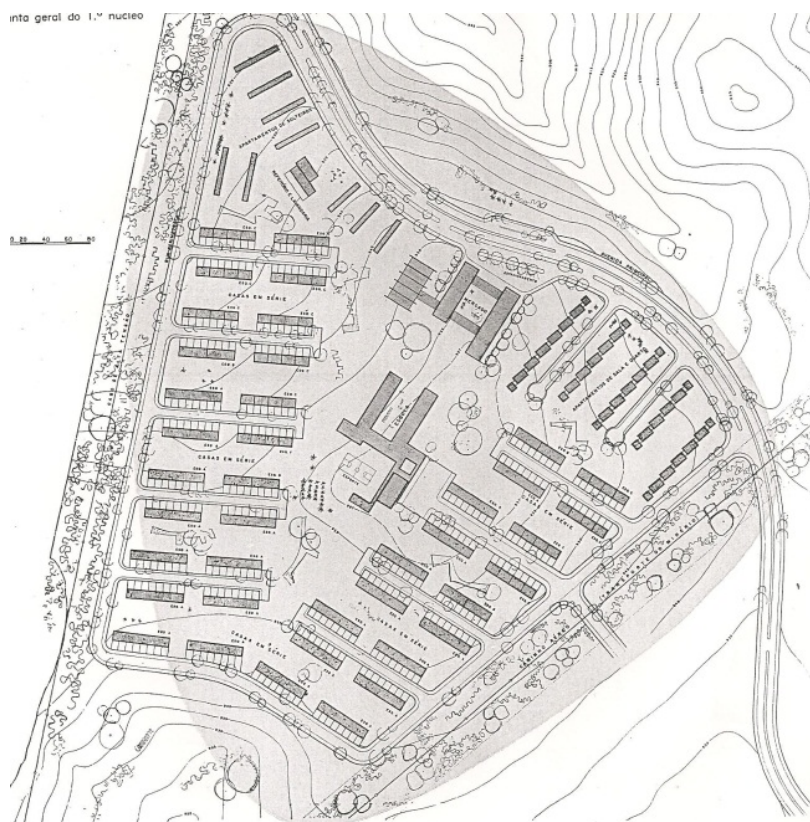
Planta Geral do 1º Núcleo Conj. Residencial para a Cia. Siderúrgica Mannesmann, Barreiro, MG. Henrique Mindlin, 1956.
